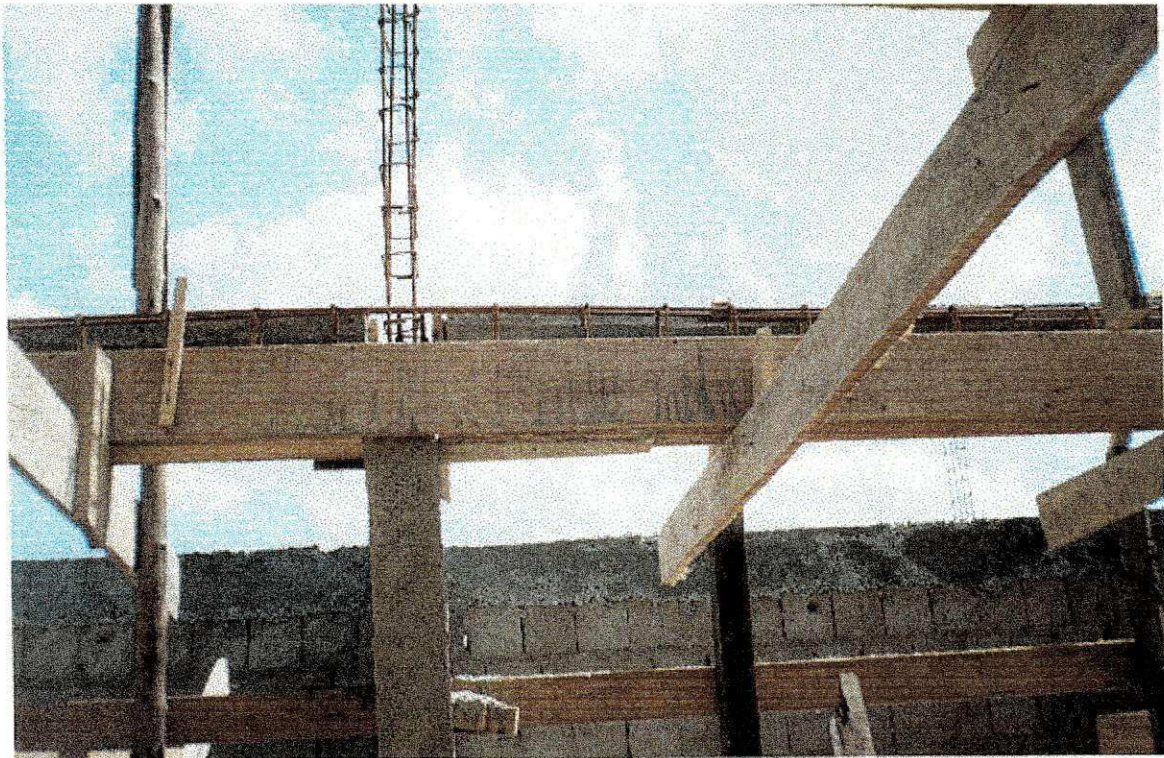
Escoramento, formamento, e colocação das armaduras em uma das vigas da obra.
